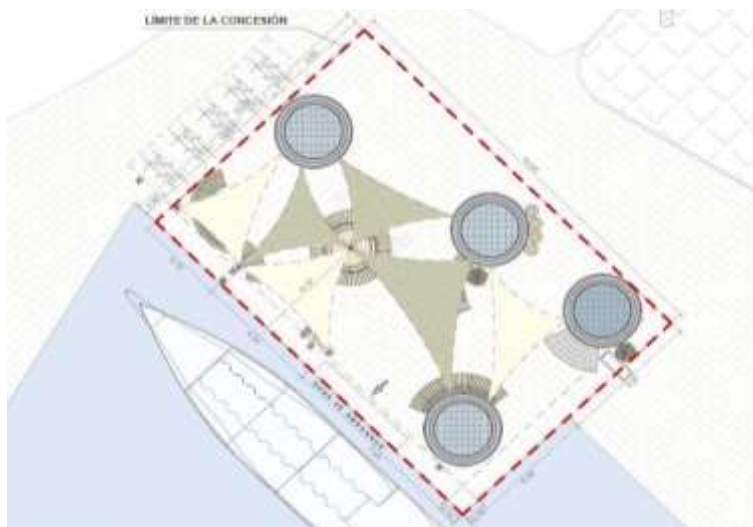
Muelles de Tránsito Local. Planta de cubiertas
